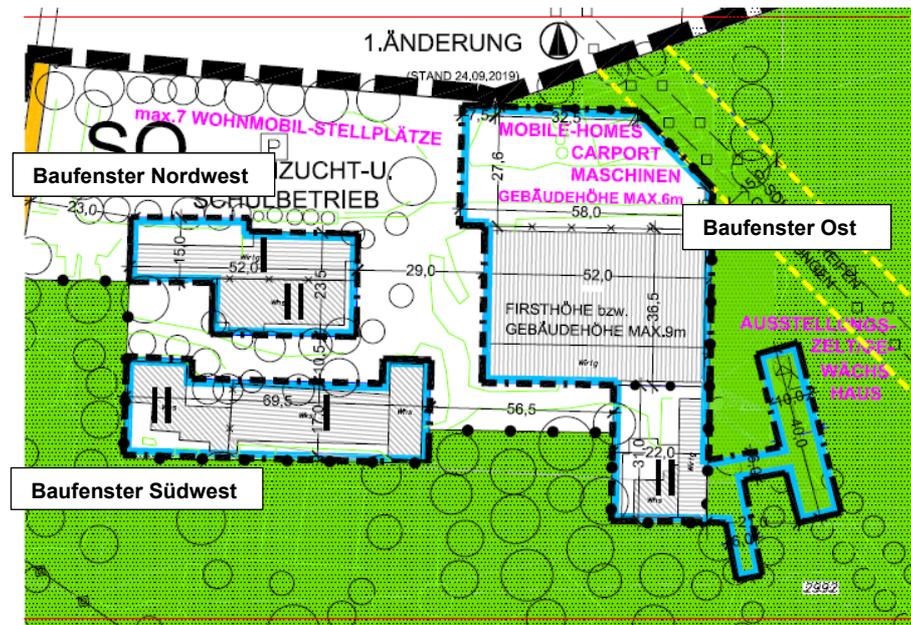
Ausschnitt Änderungsbereich 1. Bebauungsplanänderung
